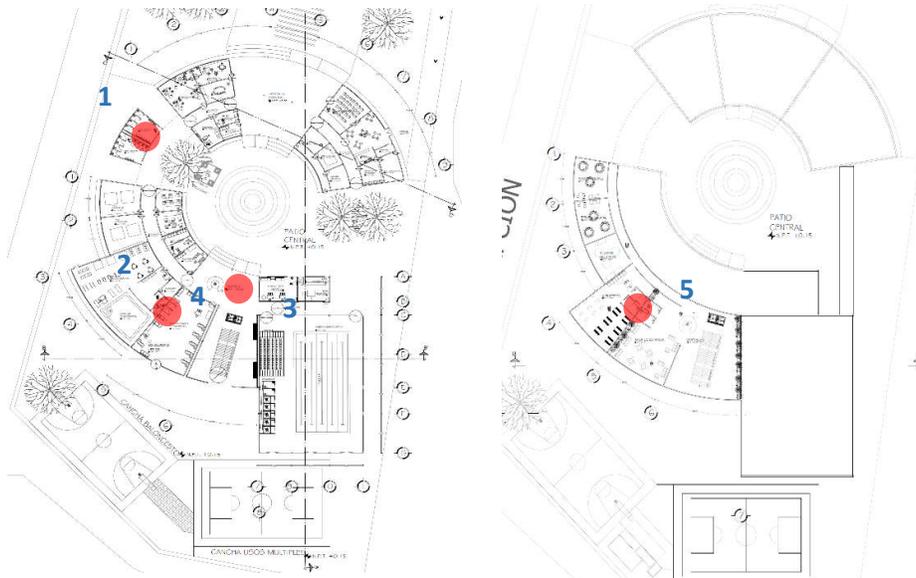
Vistas de Planta Baja y Primer Nivel del Complejo, donde se ubica la posición de los muebles sanitarios (Lavabos).
